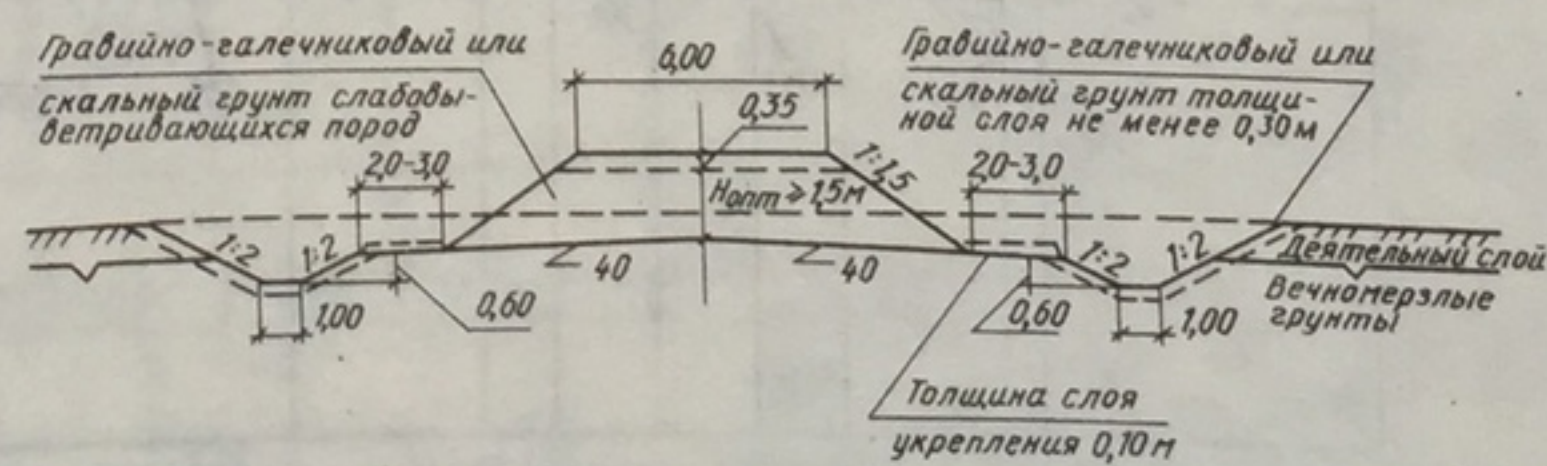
Поперечный профиль насыпи высотой менее оптимальной с заменой грунта в основании
